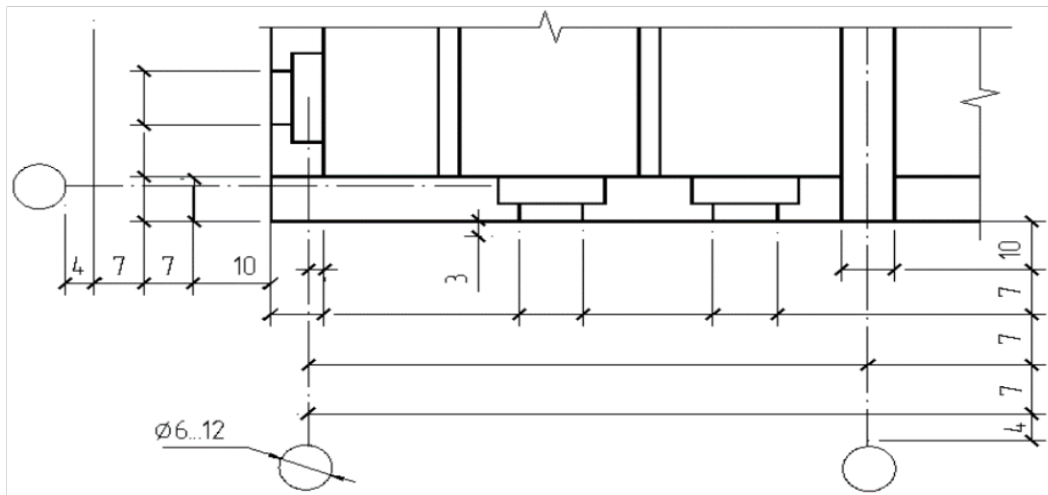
Приклад нанесення розмірних ліній на фрагменті плану будівлі
